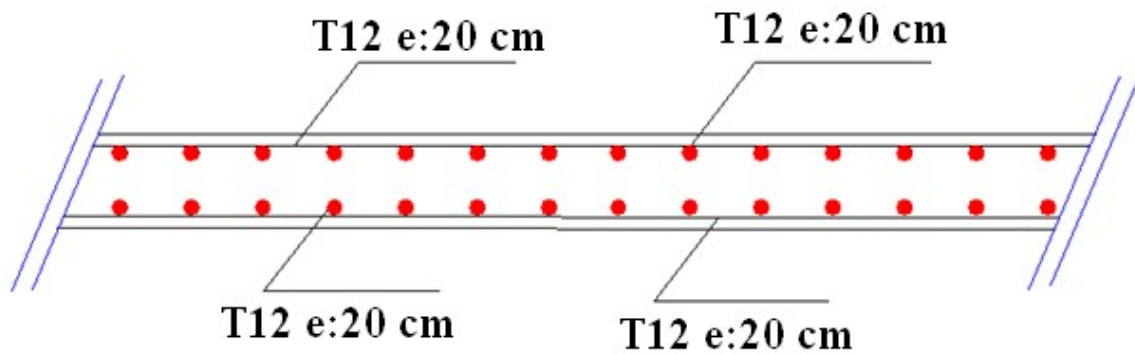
Ferrailage de la dalle pleine en plancher RDC
